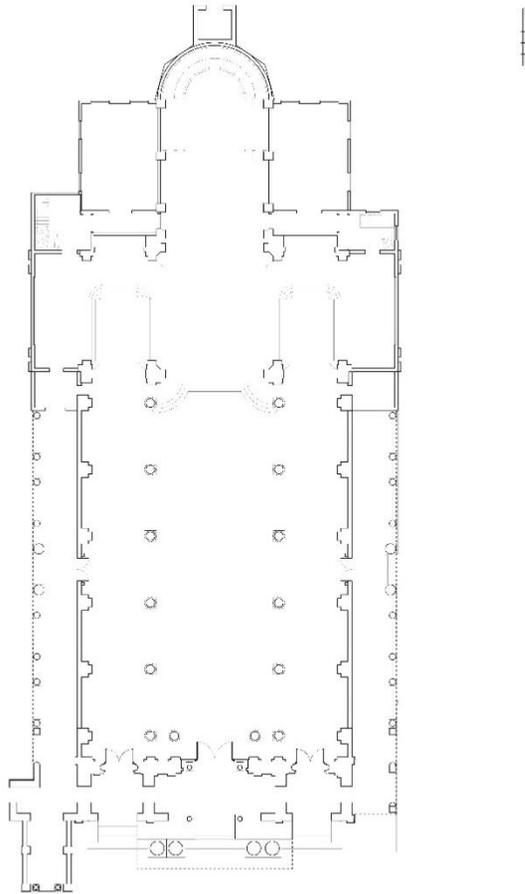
Planimetría interpretada de las elevaciones y cortes originales del Proyecto de Eduardo Provasoli. Elaboración propia
